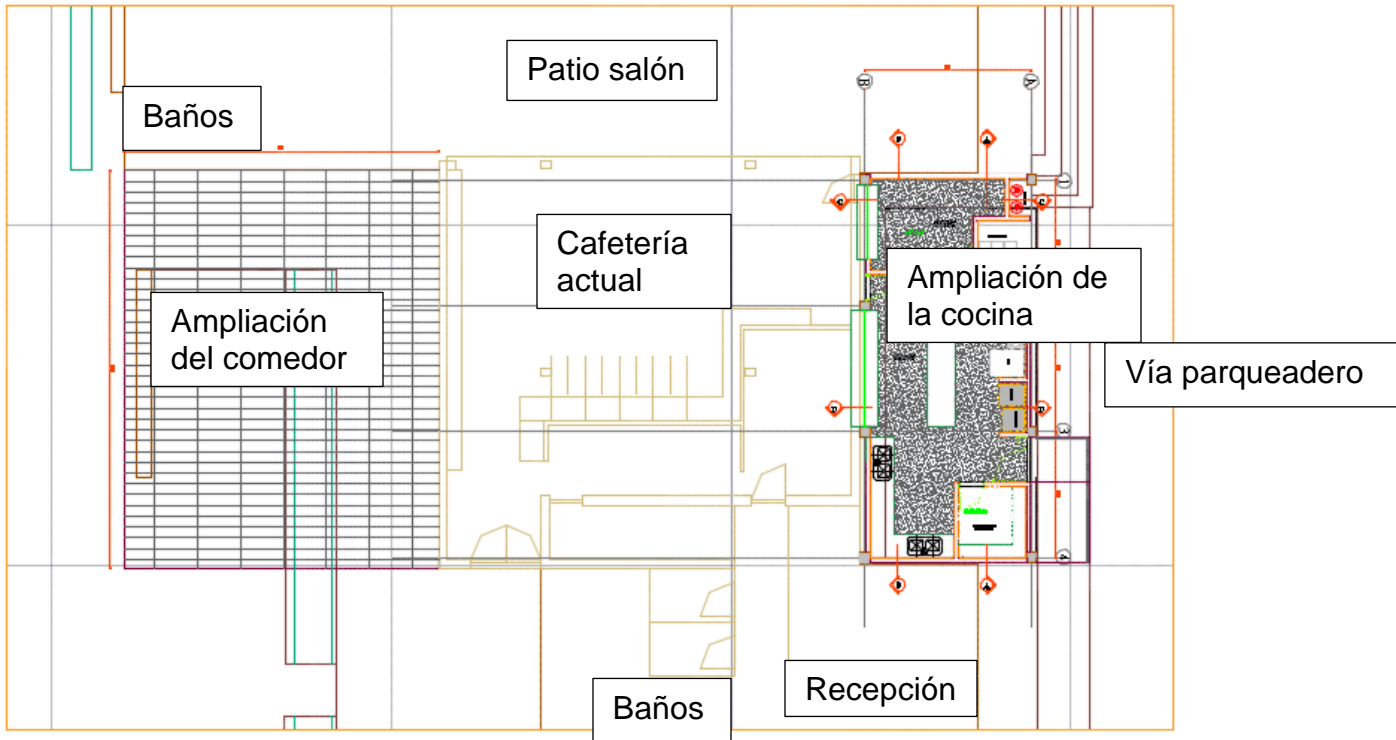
Plano en planta de la cafetería actual de la Institución.
